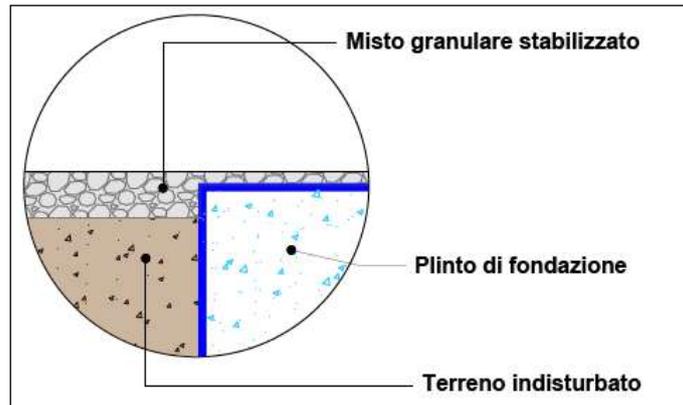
Particolare pavimentazione piazzola tipo in fase di esecuzione lavori
